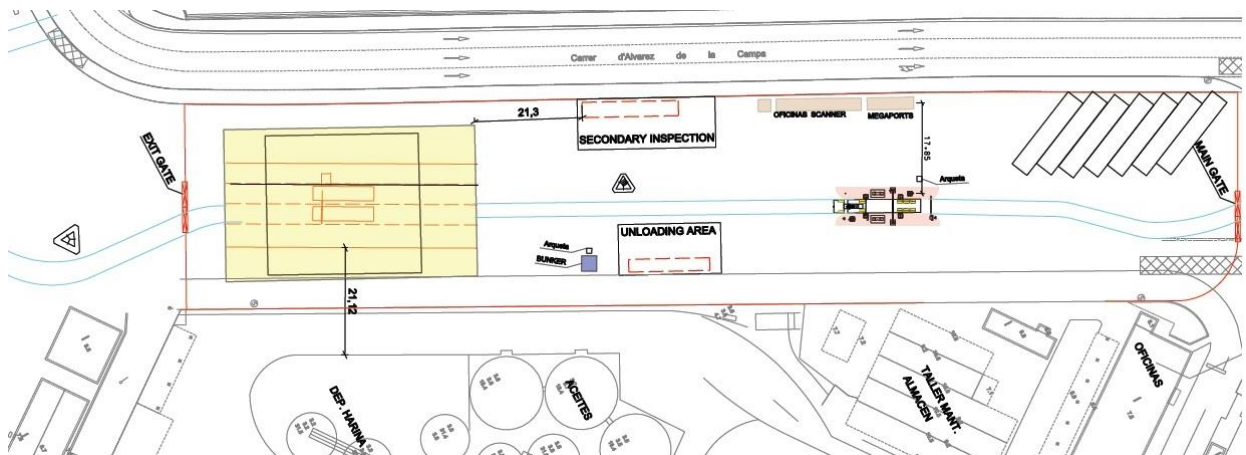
Plano en planta de Zona de Inspección Secundaria (ZIS)
